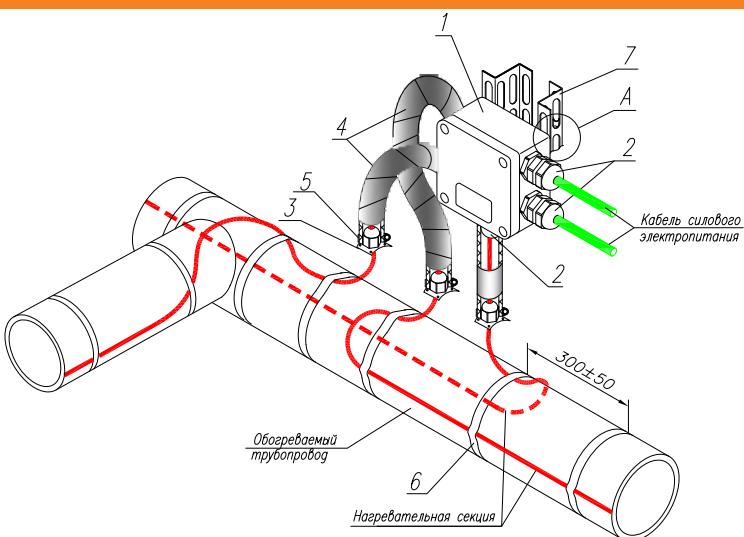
Узел монтажа соединительной коробки РТВ 602 на близлежащих металлоконструкциях.
